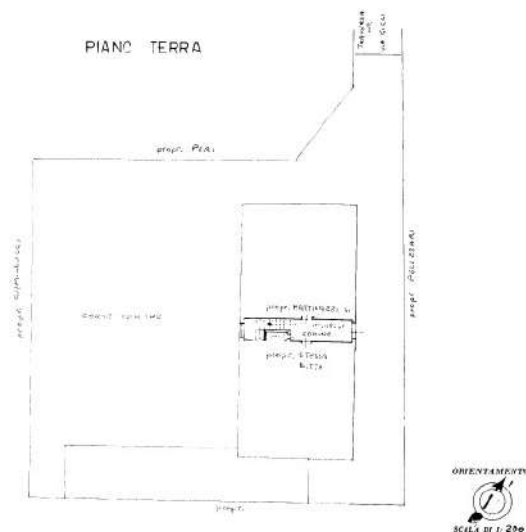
Estratto planimetria catastale fg. 7 map. 164 sub. 3
